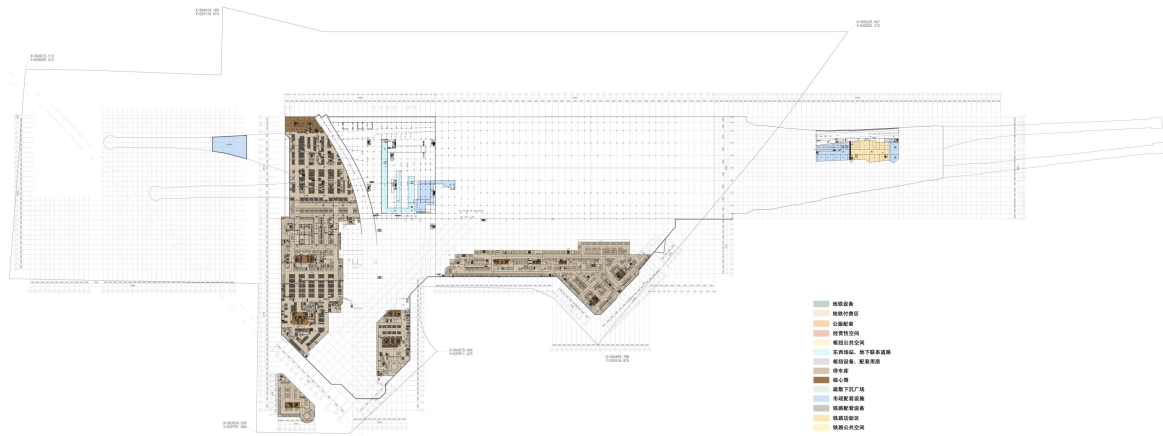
(c) 地下 1.5 层（以下简称 B1.5 层）平面
